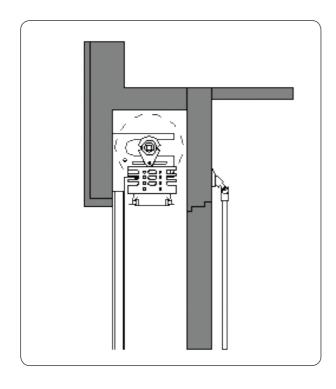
Einbau in bestehenden Hohlsturz mit Untersichtsblende: Neubau und Sanierung
